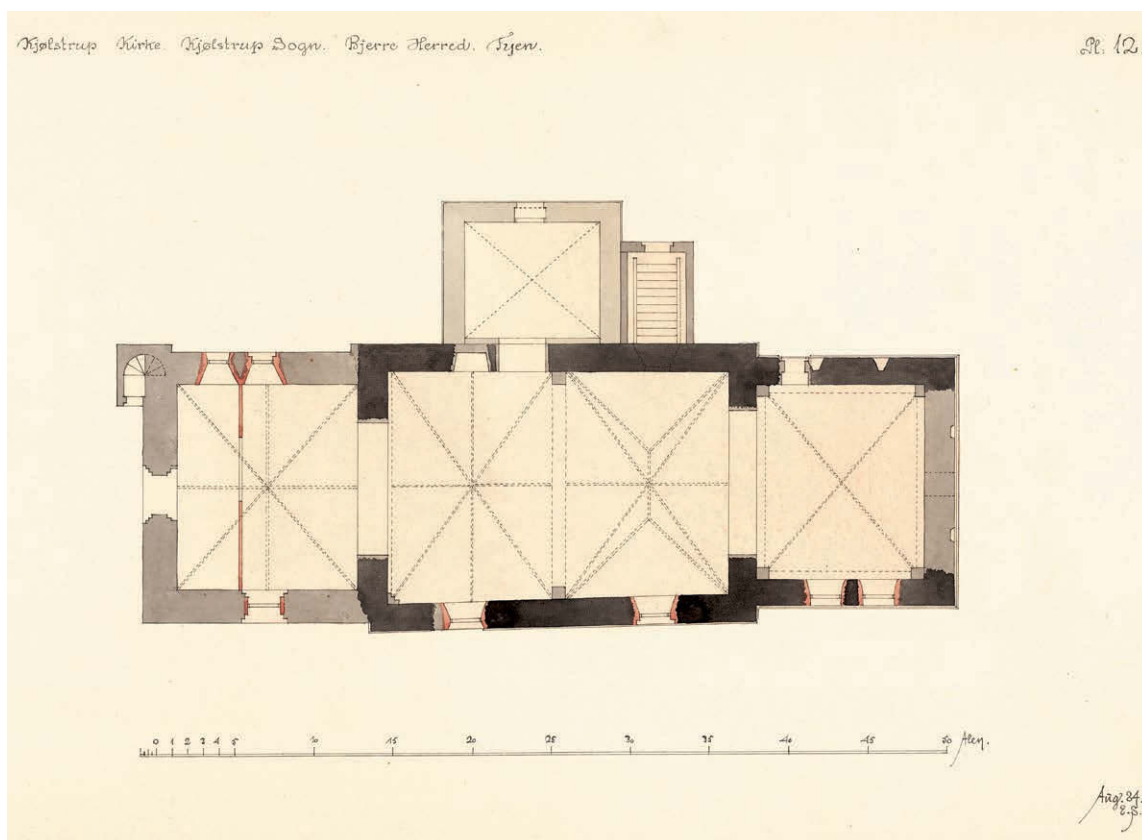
Plan. 1:300. Målt og tegnet af Erik Schiødt 1884. – Plan.
